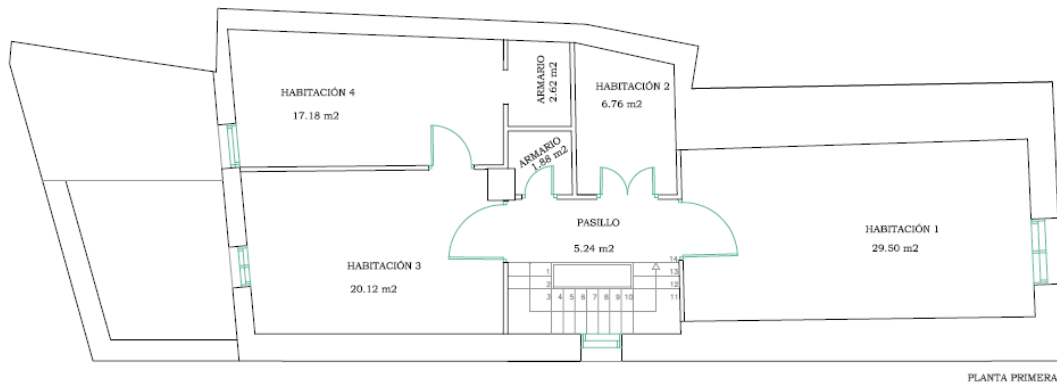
Plano distribución y superficies planta primera Anexo 9.2 P.7
